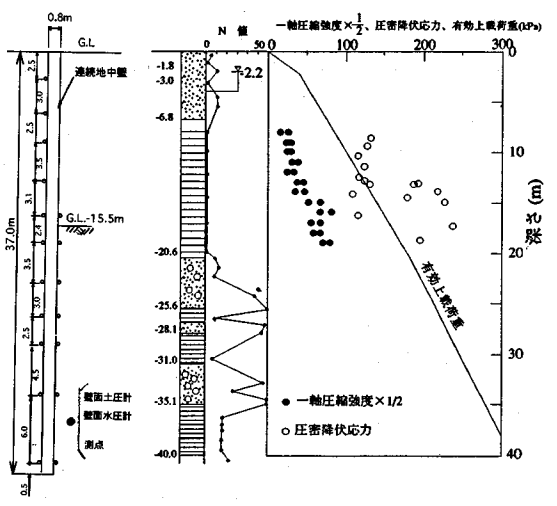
計測器設置位置図 図-6 地盤状態 (B 地点土留め工)
